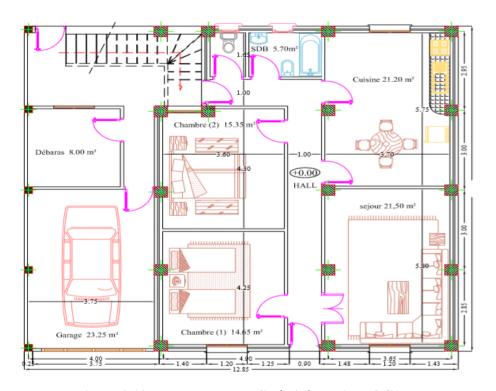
vue en plan RDC réalisé par AUTOCAD
